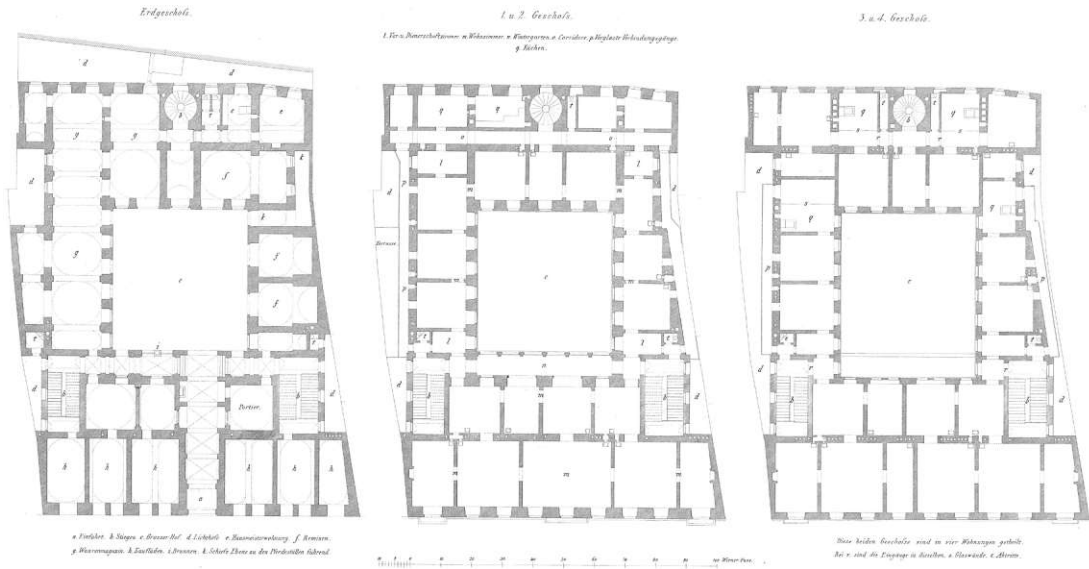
Grundrisse Wohnhaus Renngasse - Ludwig Christian Förster, 1844
